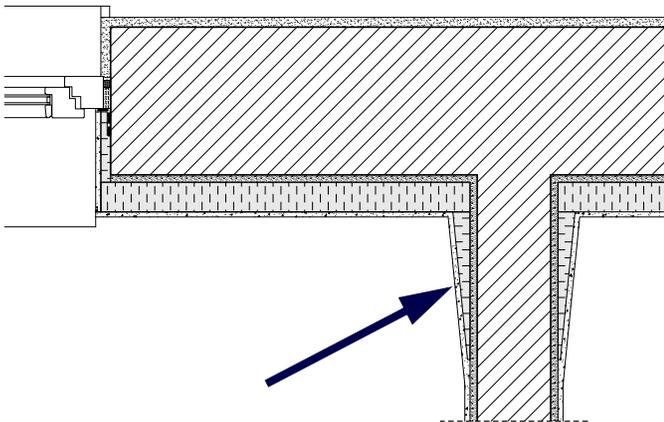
Einbindende Bauteile können mit Dämmkeilen ausgestattet werden. Damit ist die Wärmebrücke und Schimmelgefahr an den Übergangsbereichen unterbunden.
